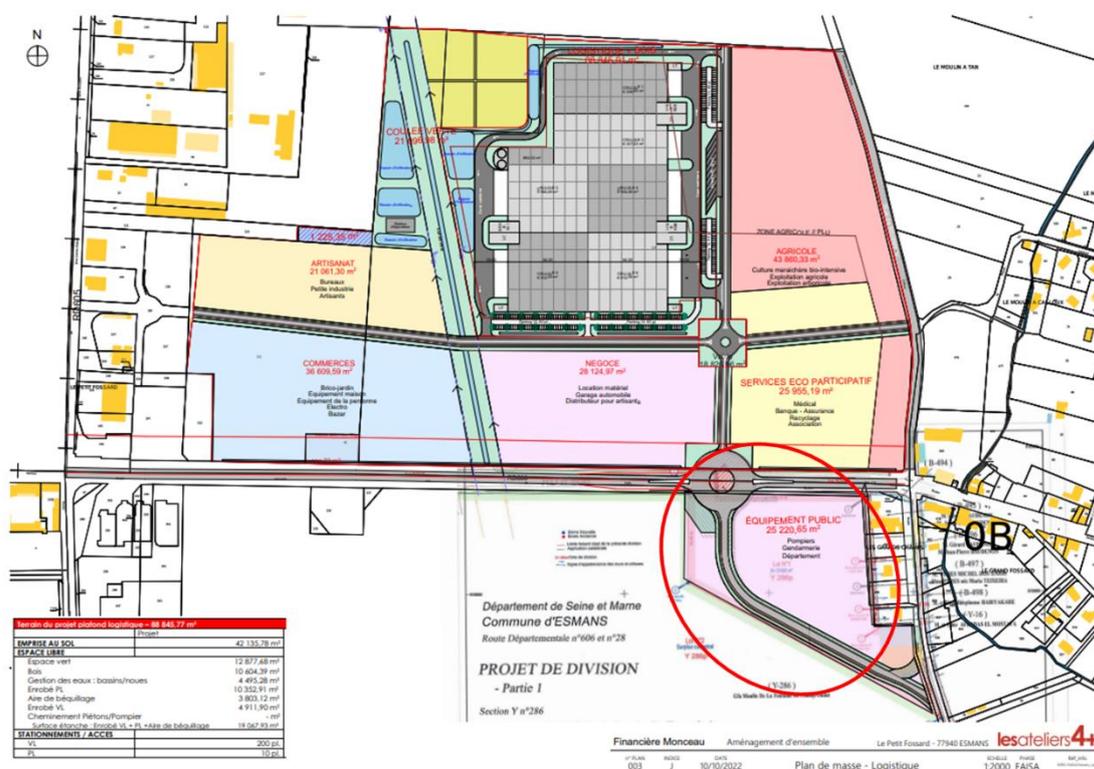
Présentation du projet sur fond de plan cadastral (source : lesateliers4+)
